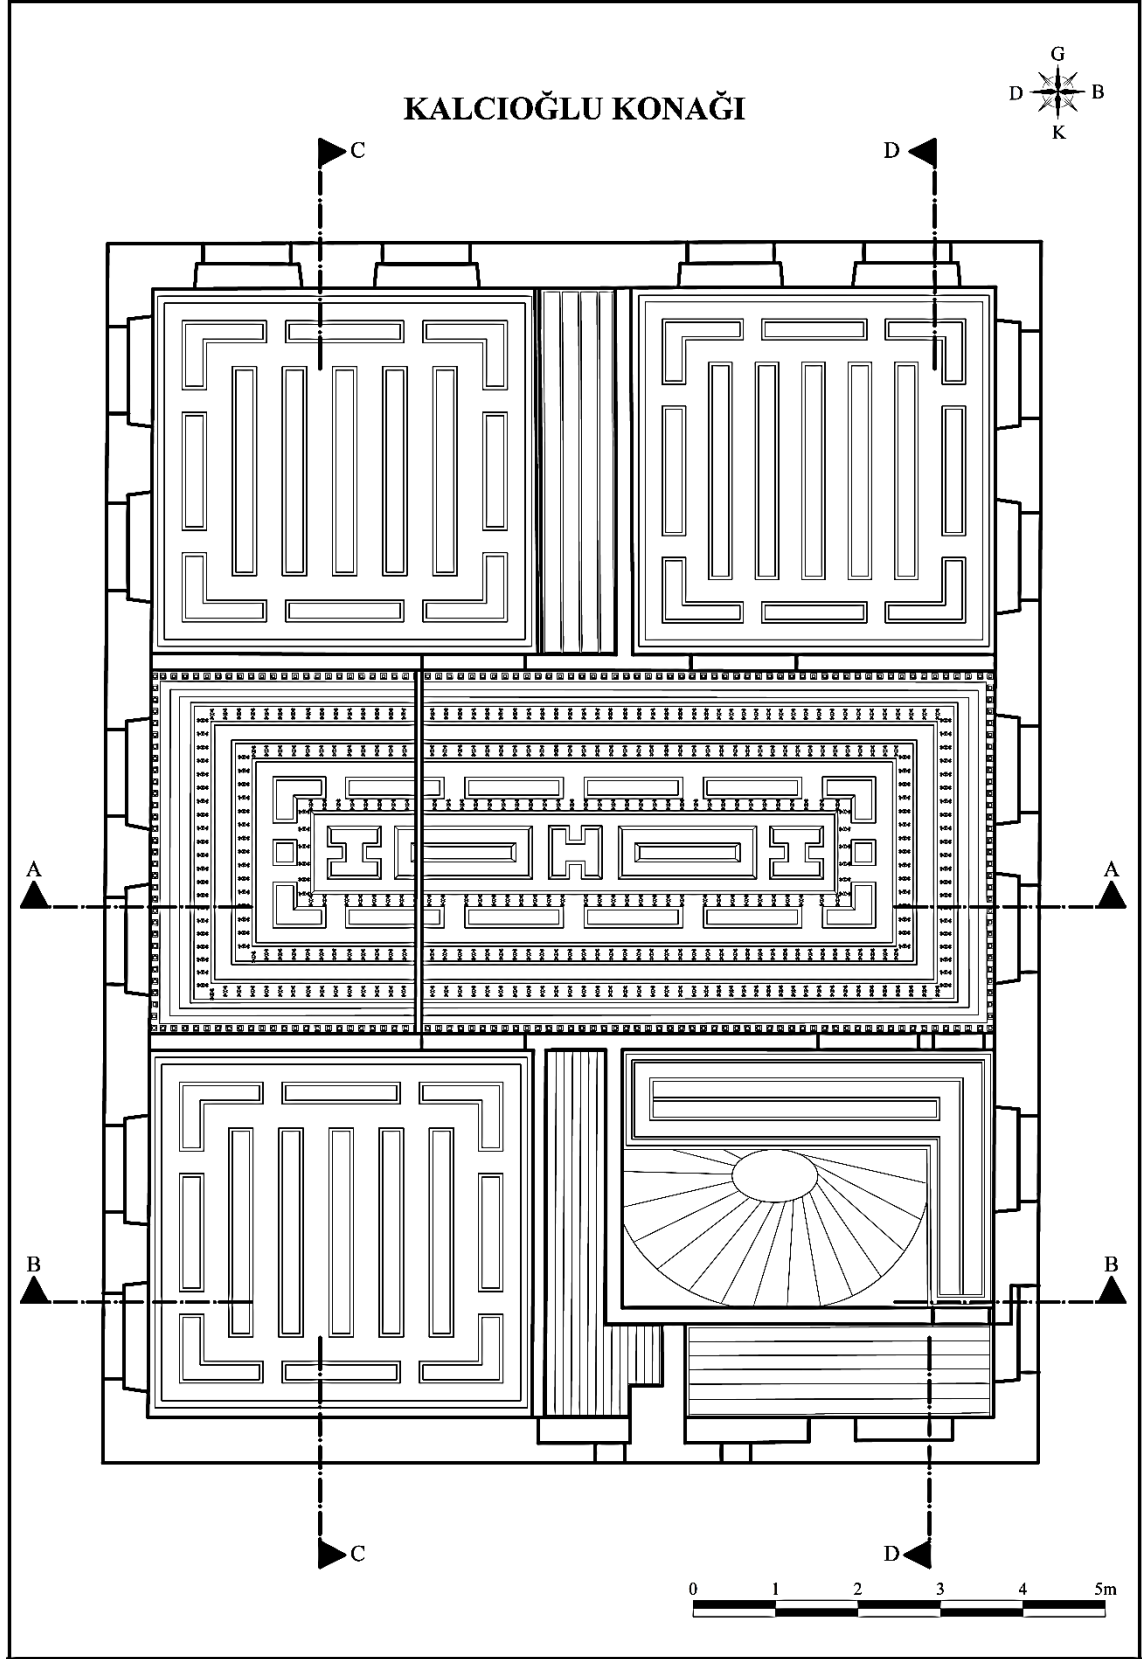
Rölöve- Çatı Katı Planı (Turhan, 2013)
